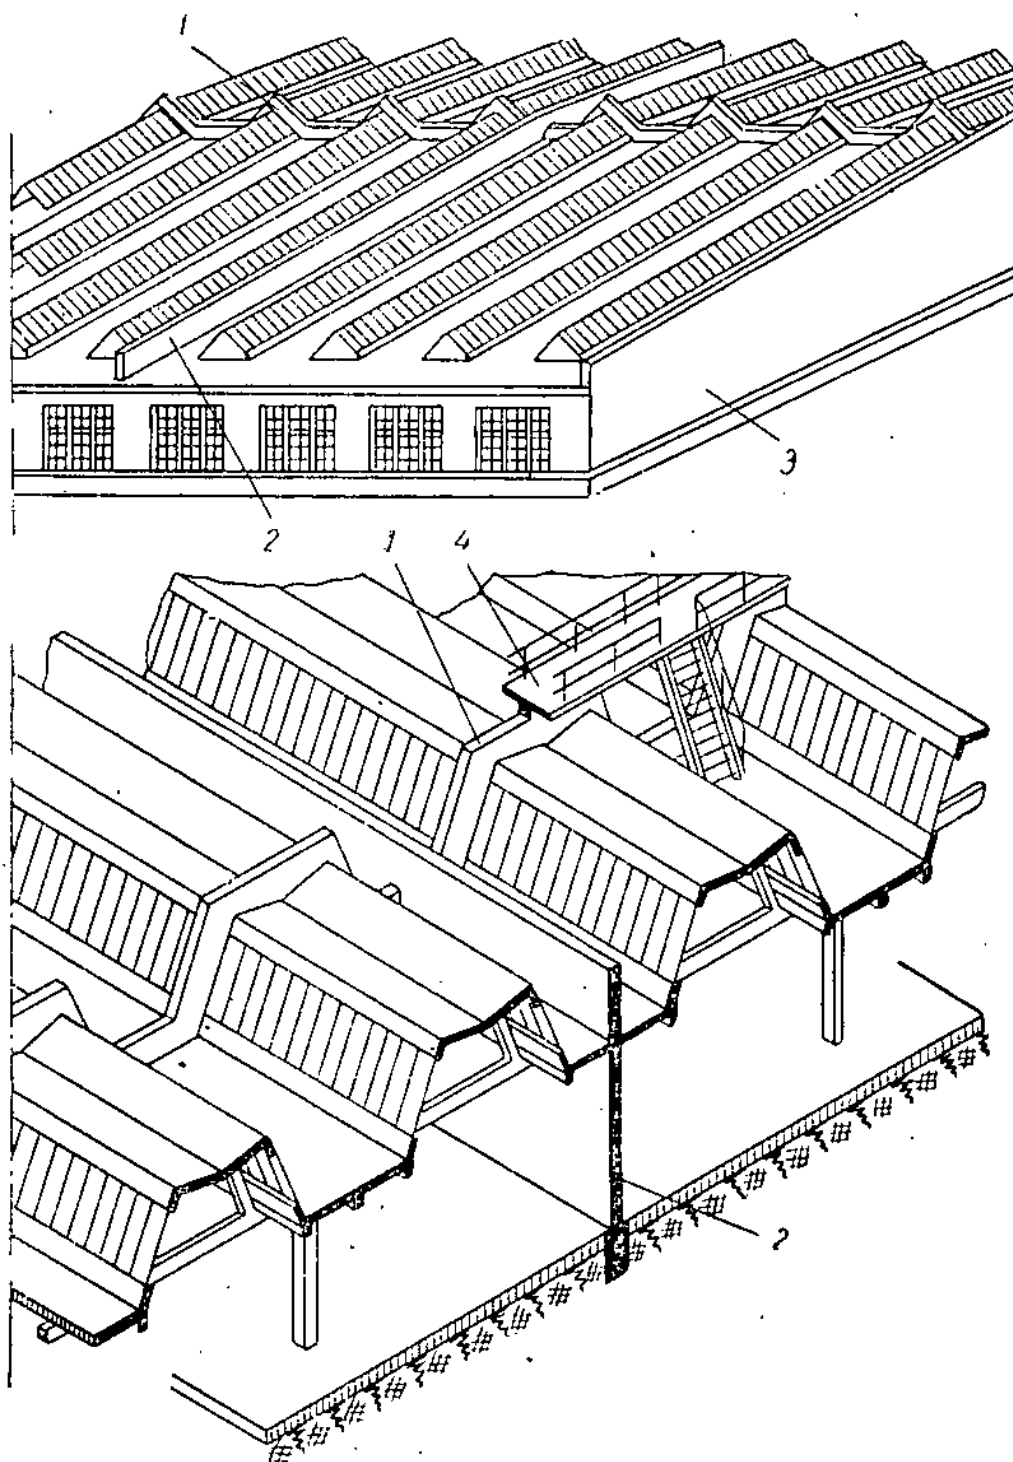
Устройство продольных и поперечных брандмауэров в одно-этажных промышленных зданиях
